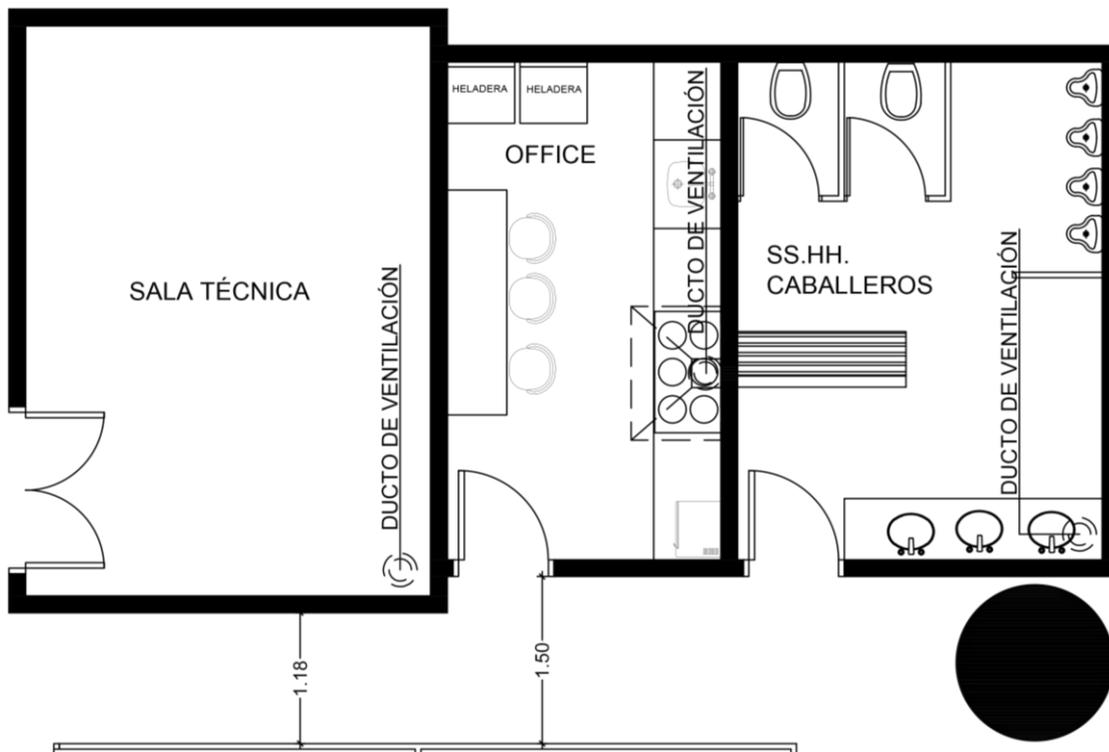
Elaboración Propia. Propuesta 1. Planta arquitectónica del Office.
